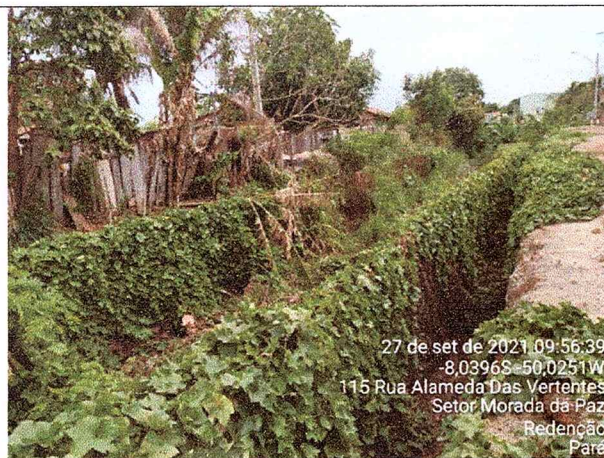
Vista do local onde será construído canal em calha de concreto moldado "in loco", já com as ferragens das paredes.
